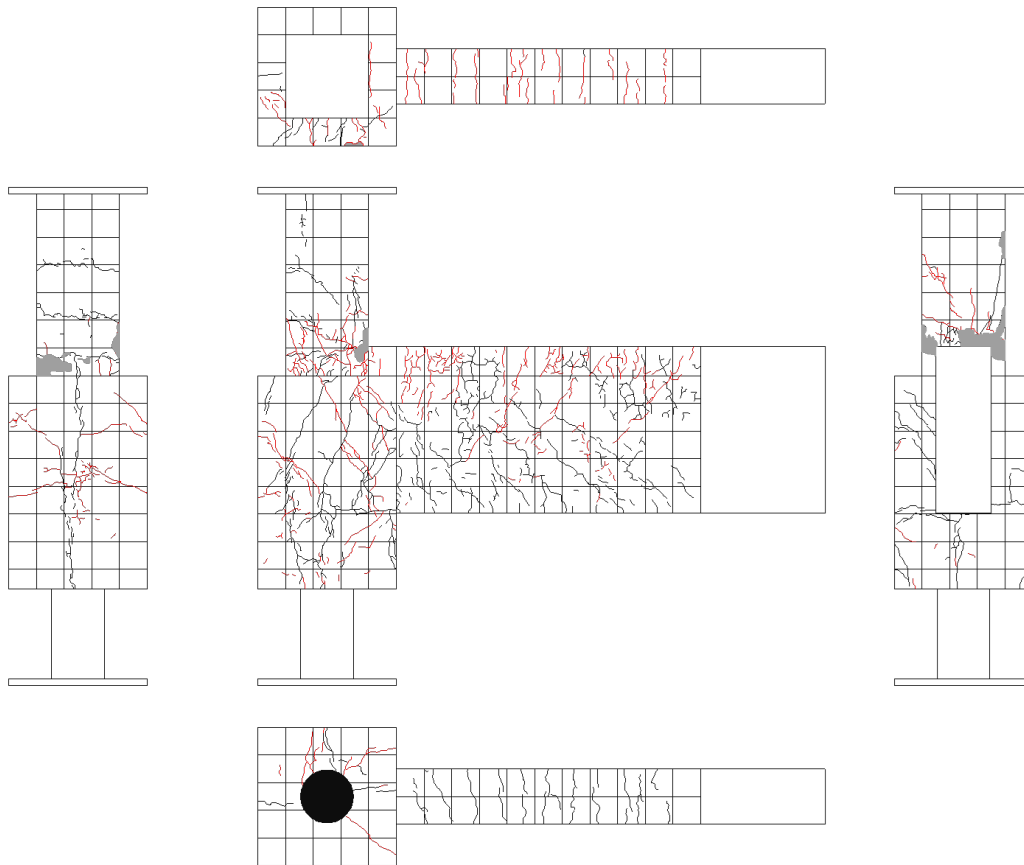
3. 161 試験体 A-7b ひび割れ状況 (8Cycle)
